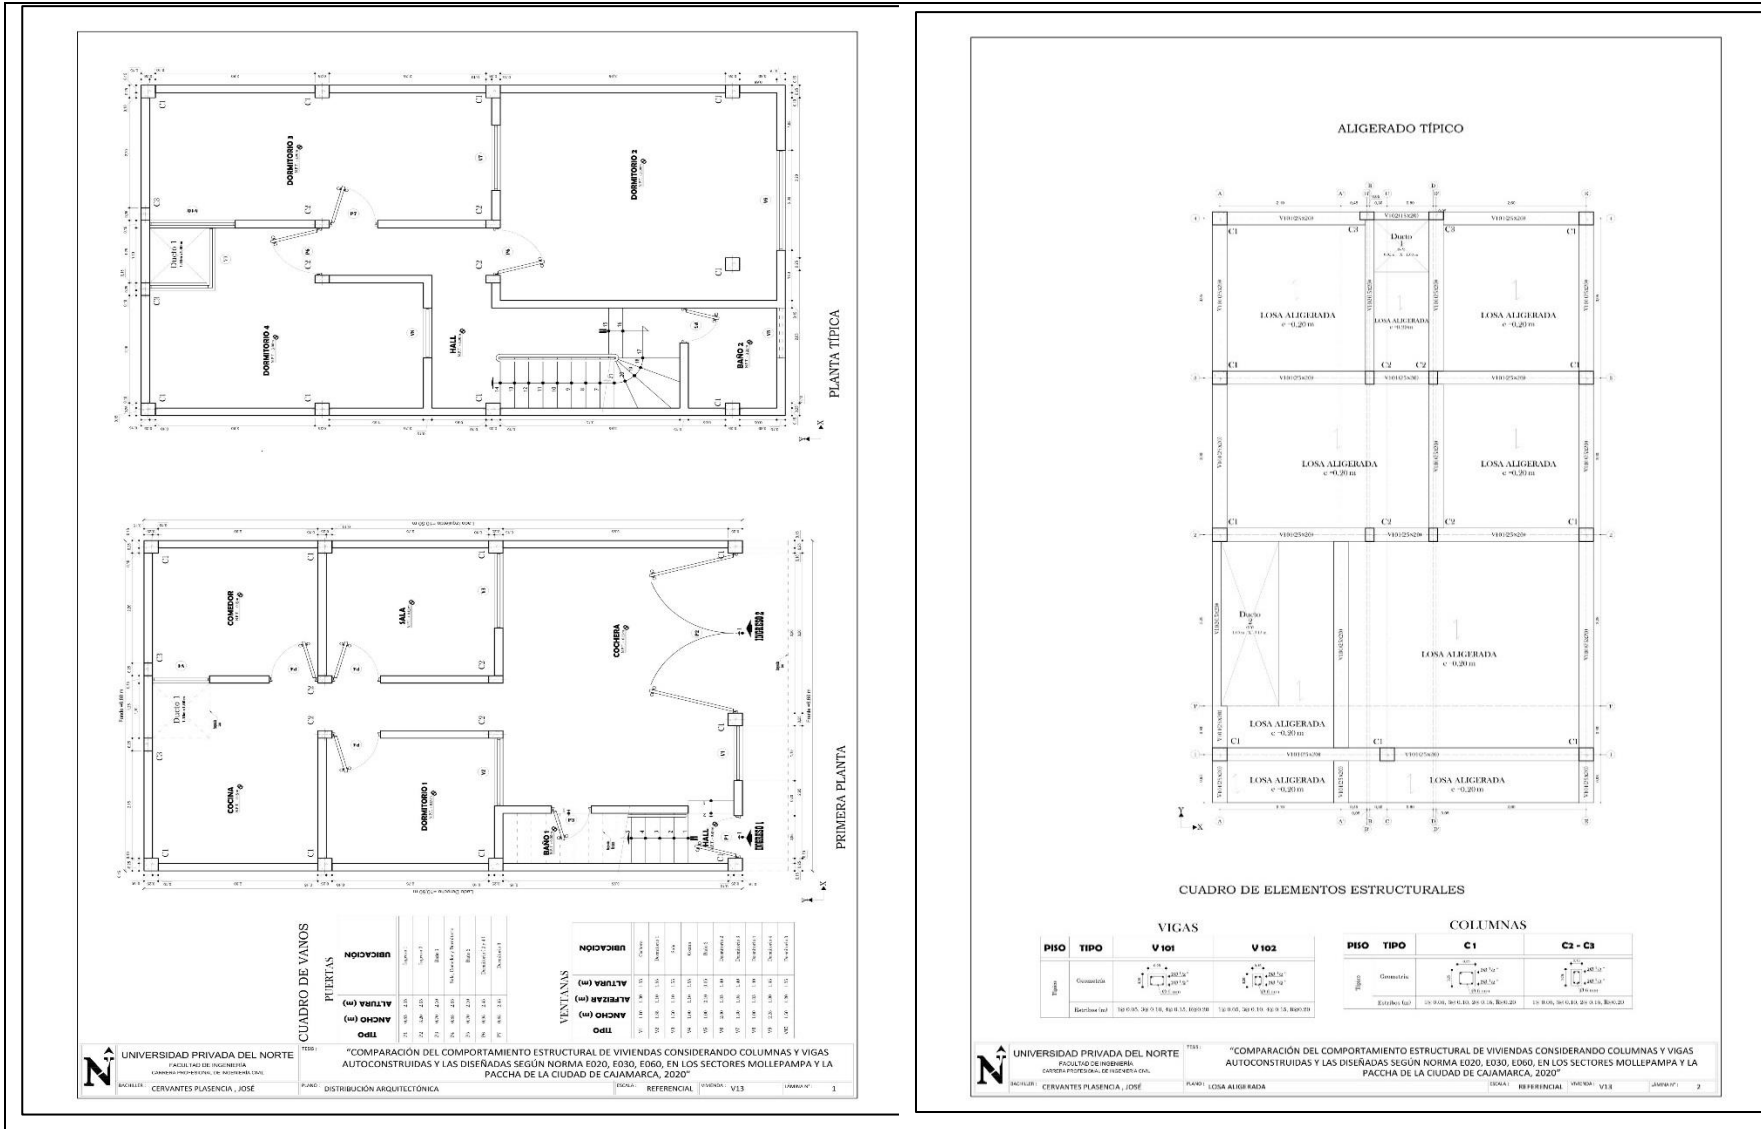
Plano de arquitectura y losa aligerada vivienda 13
